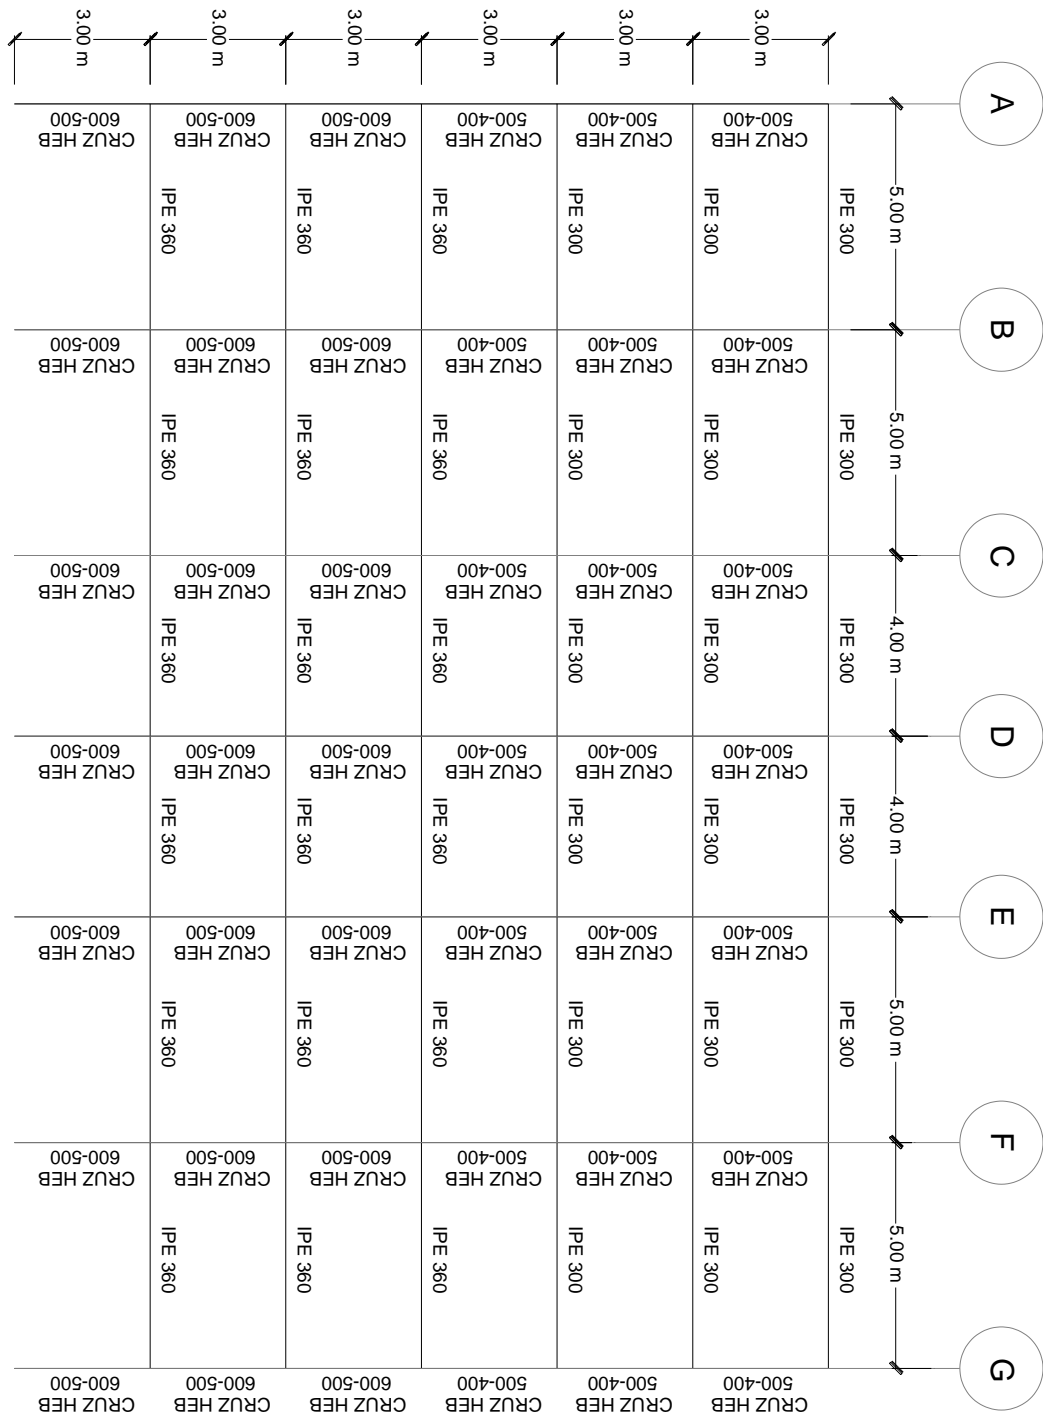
Secciones utilizadas vista en elevación ejes 1, 5.
